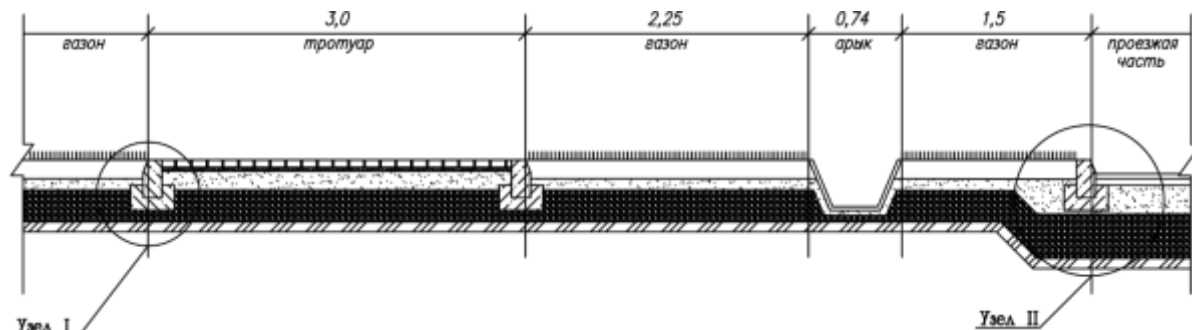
Конструктивный разрез дорожного полотна (чертеж автора)
